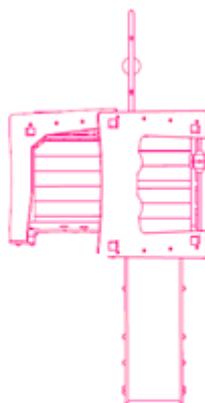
Caseta con tobogán y dibujo en planta
